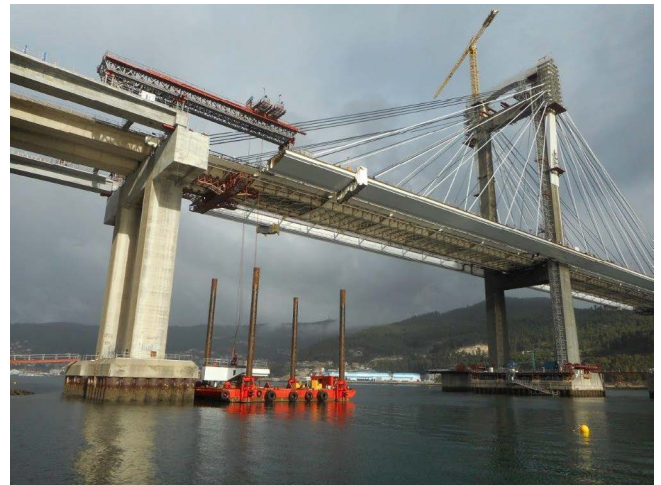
Viga de elevación de dovelas de extremo en el lado sur.
